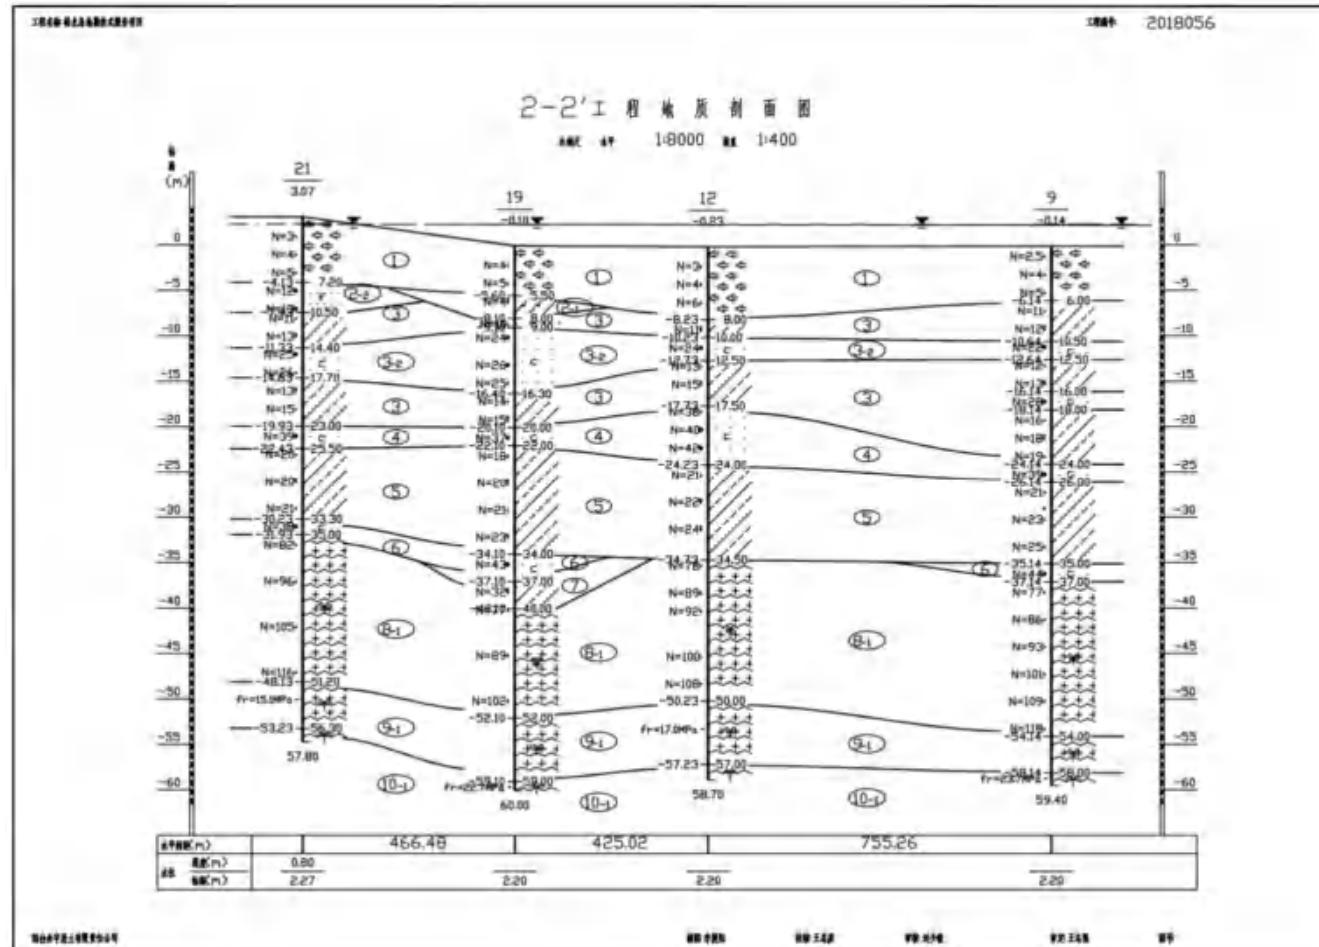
典型工程地质剖面图 (2-2' 剖面)
